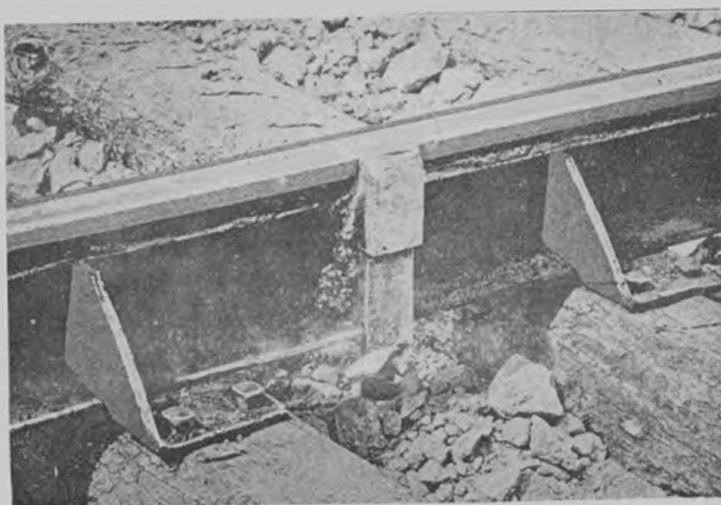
VUE DE LA SOUDURE D'UN RAIL
